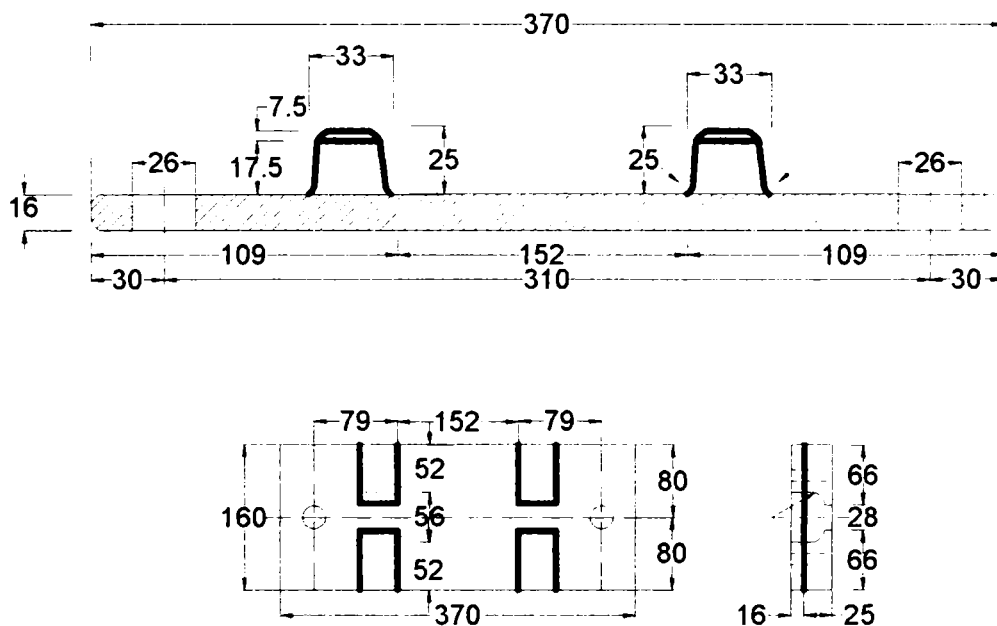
Placă metalică tip 49 (60) cu înclinare.
